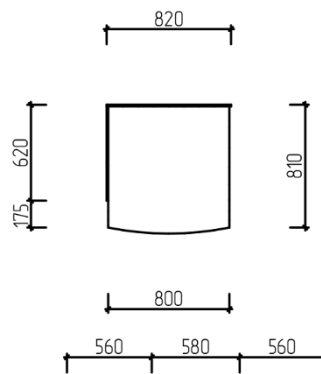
Чертеж оборудования. Вид сбоку
